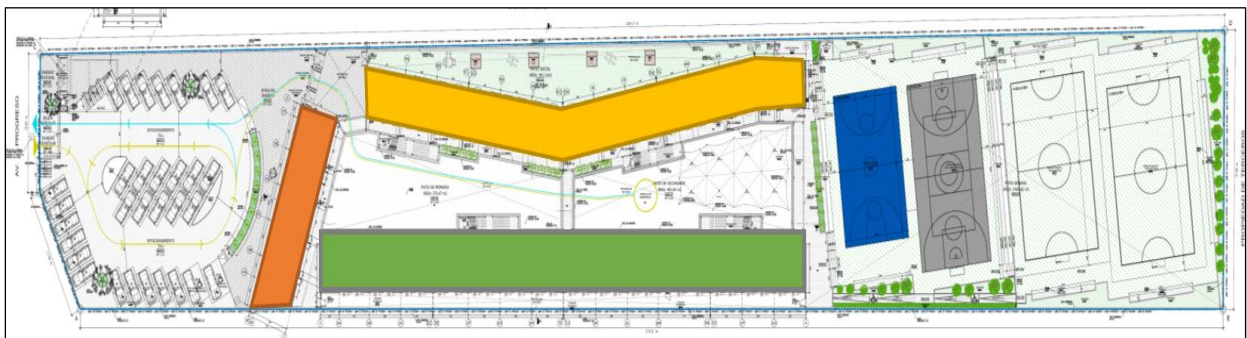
Planta de arquitectura (Bloques). Elaborado por: Adolfo Chávez y arquitectos asociados.
